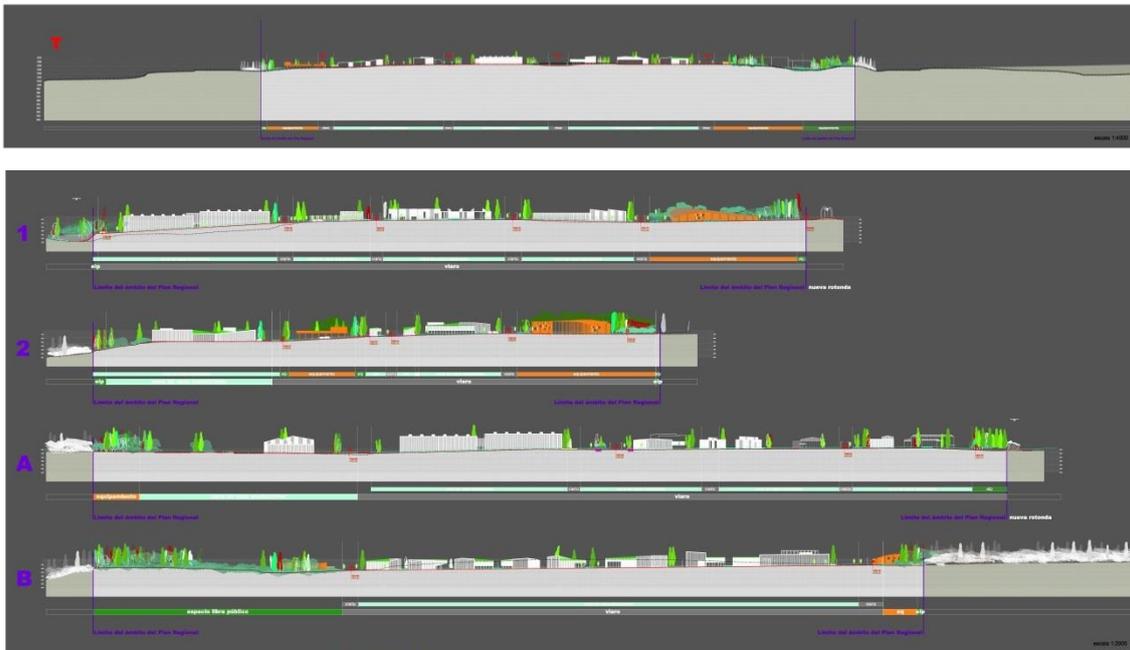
Detalles de secciones modelizadas del ámbito del PRAT
